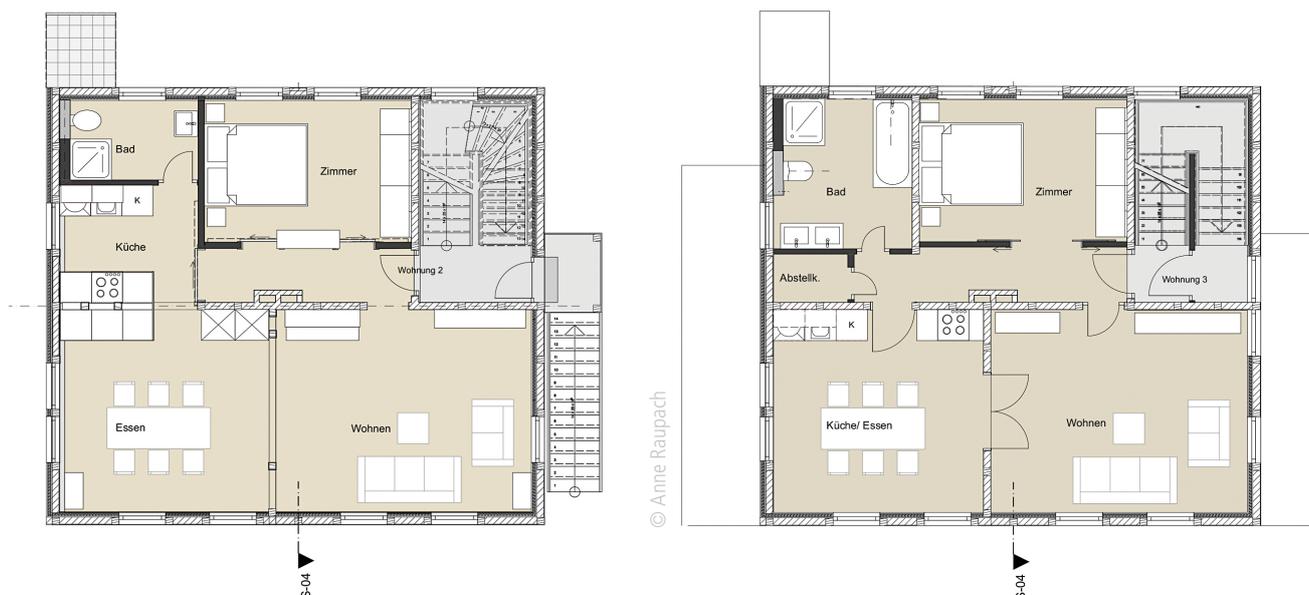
Grundriss erstes und zweites Wohngeschoss nach der Sanierung
